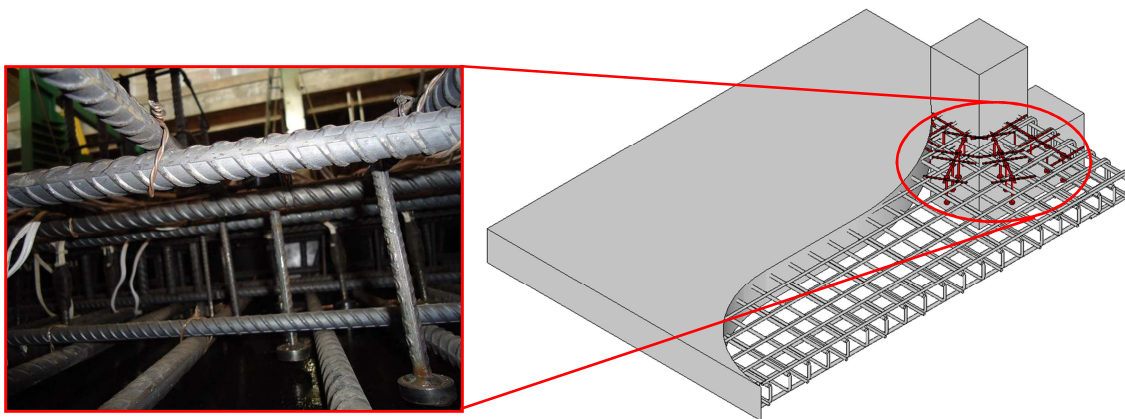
Lajes com armadura de cisalhamento (*studs*)
